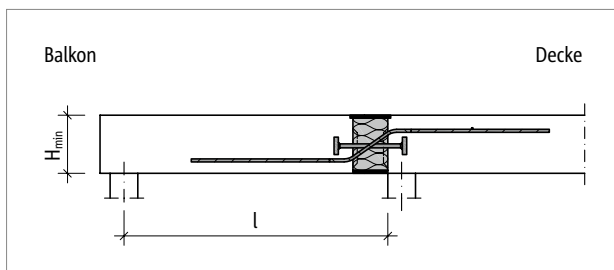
Schöck Isokorb® XT Typ QP: Statisches System
